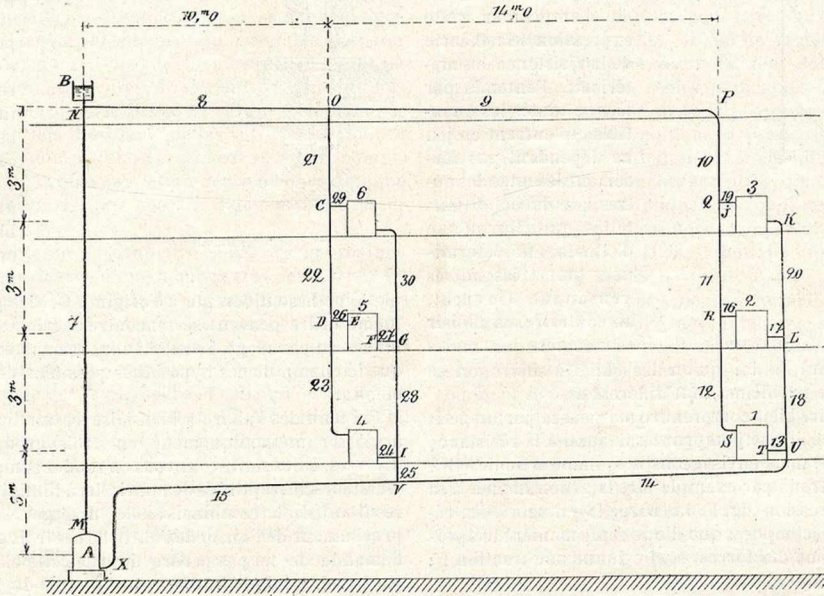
Schéma d'une installation de chauffage à eau chaude avec distribution par le haut.
